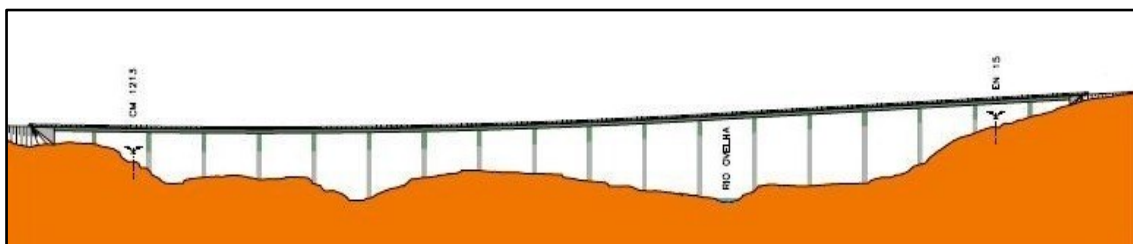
Perfil longitudinal da ponte do Caso de Estudo 1
